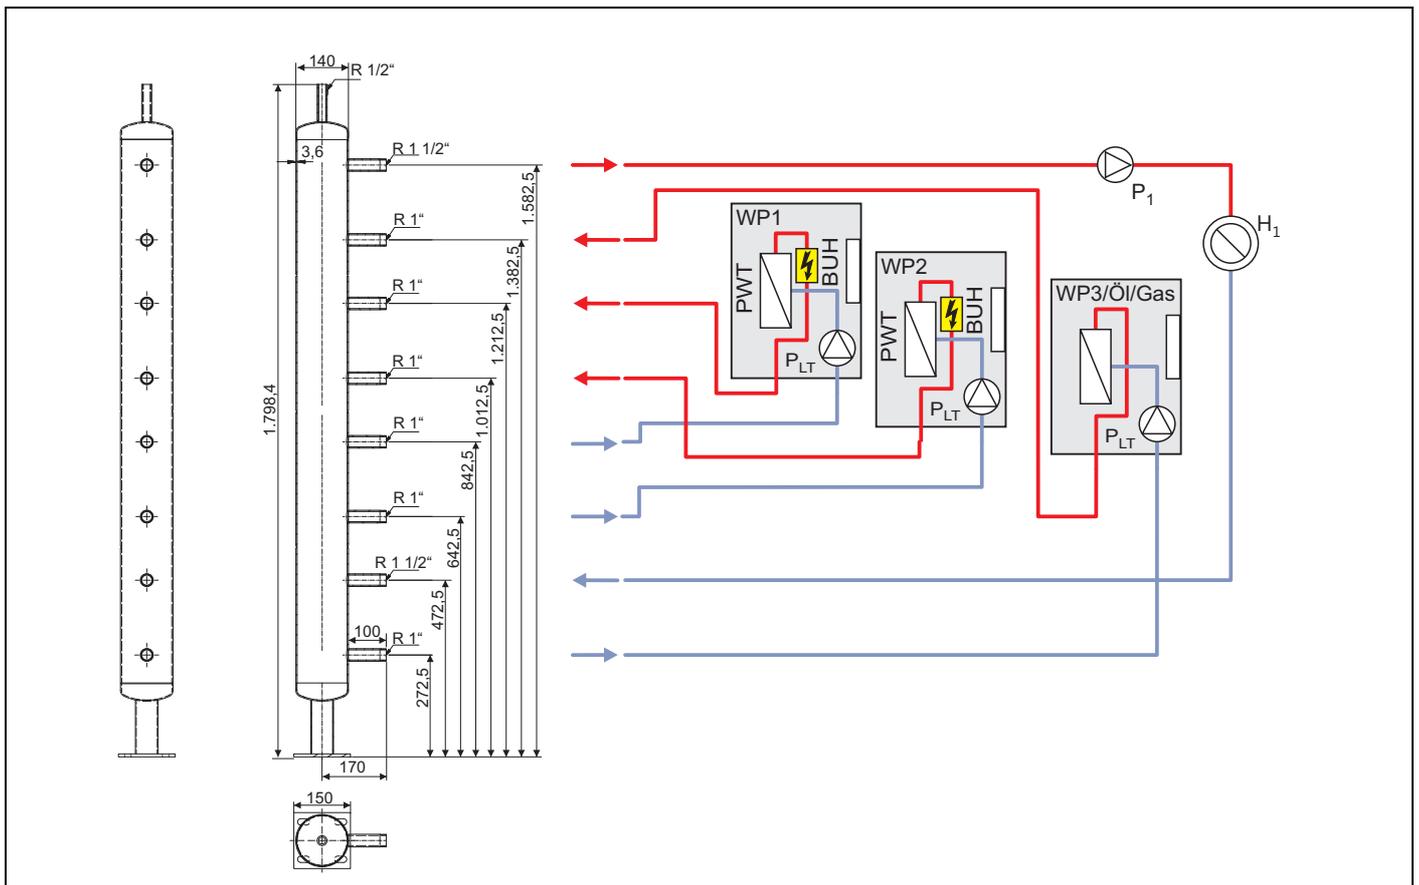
Hydraulische Weiche: Abmessungen und Anschlüsse
